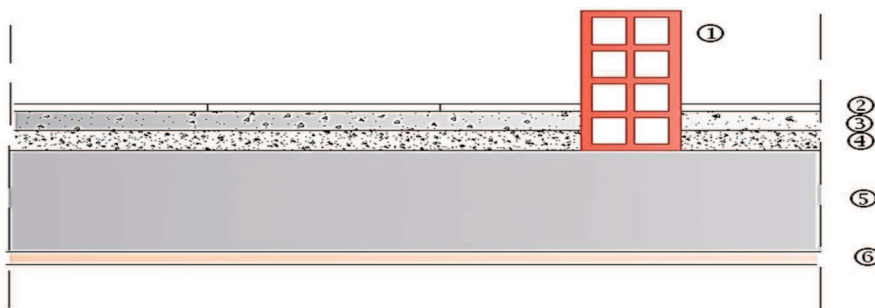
Coupe d'un plancher d'étage courant en dalle pleine.
